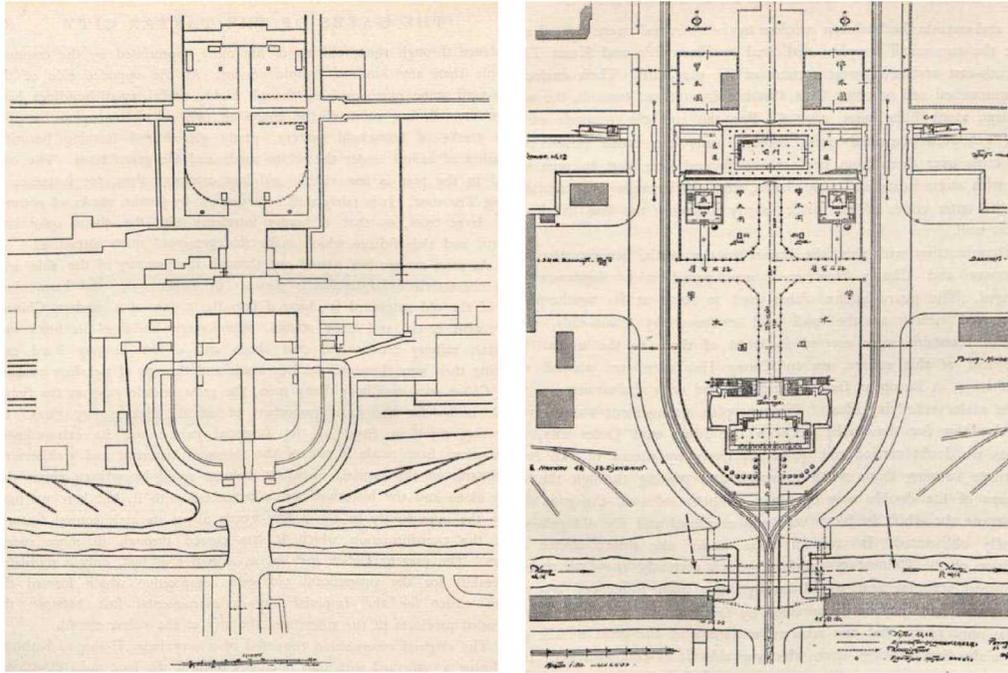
左：改造前的正阳门平面图，右：改造后的正阳门平面图
